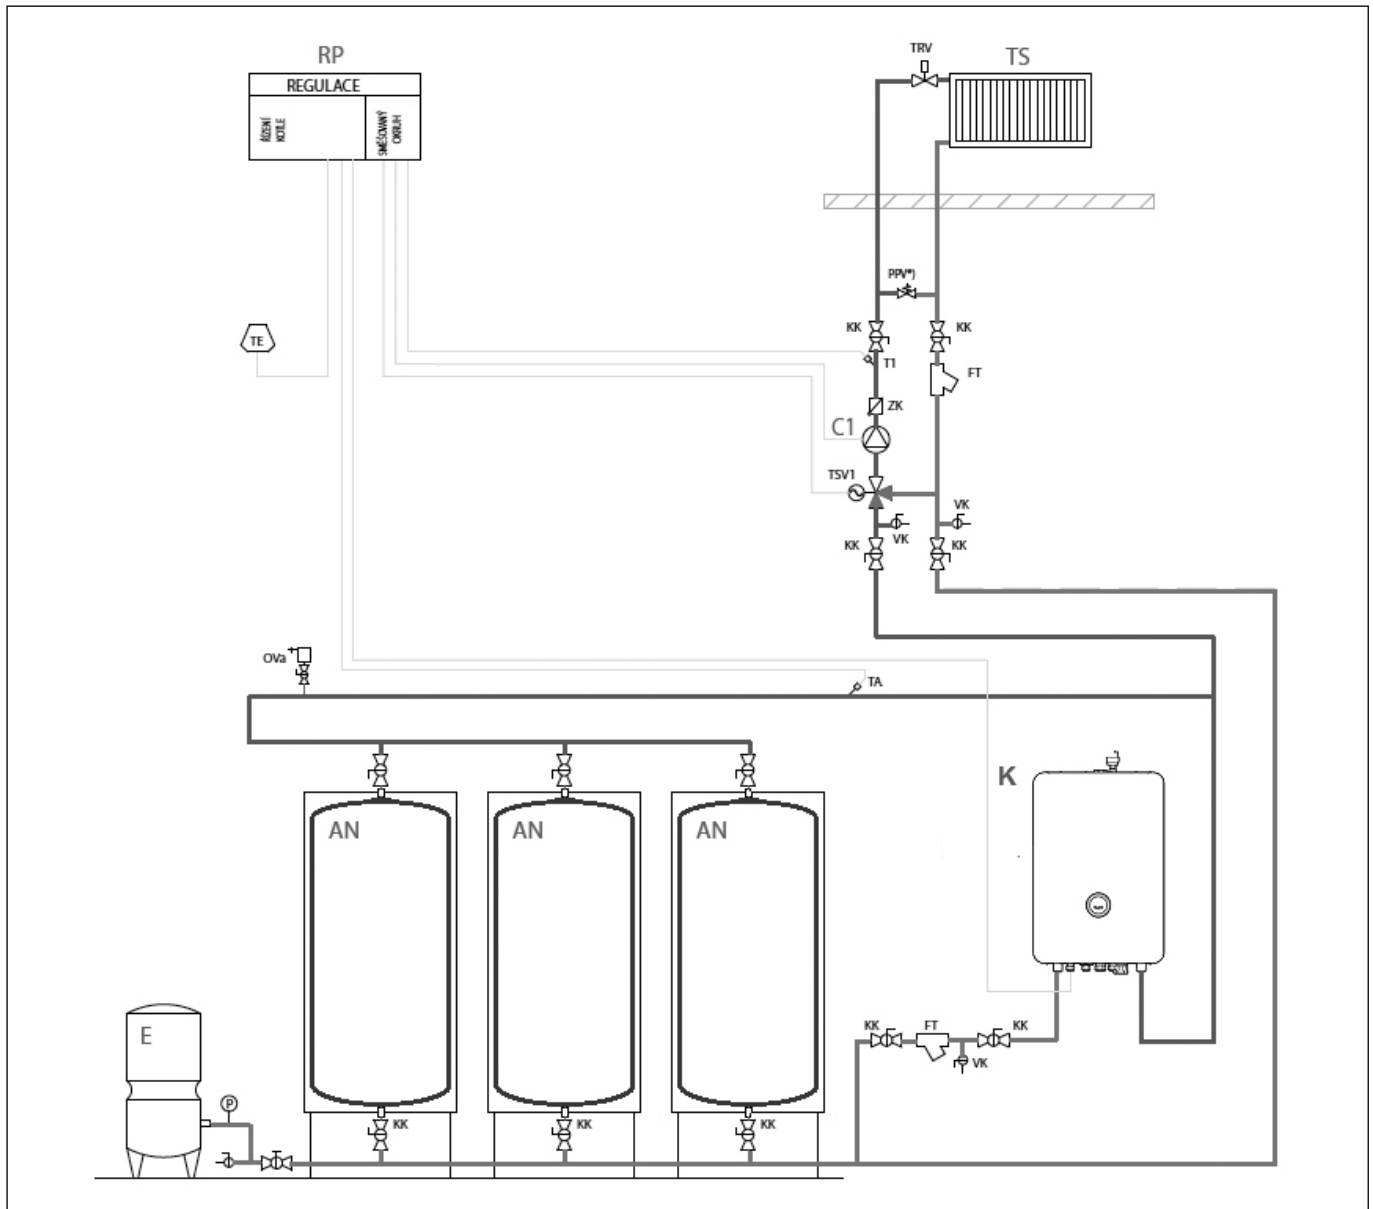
Zapojení elektrokotle jako záložního zdroje tepla pro otopnou soustavu
